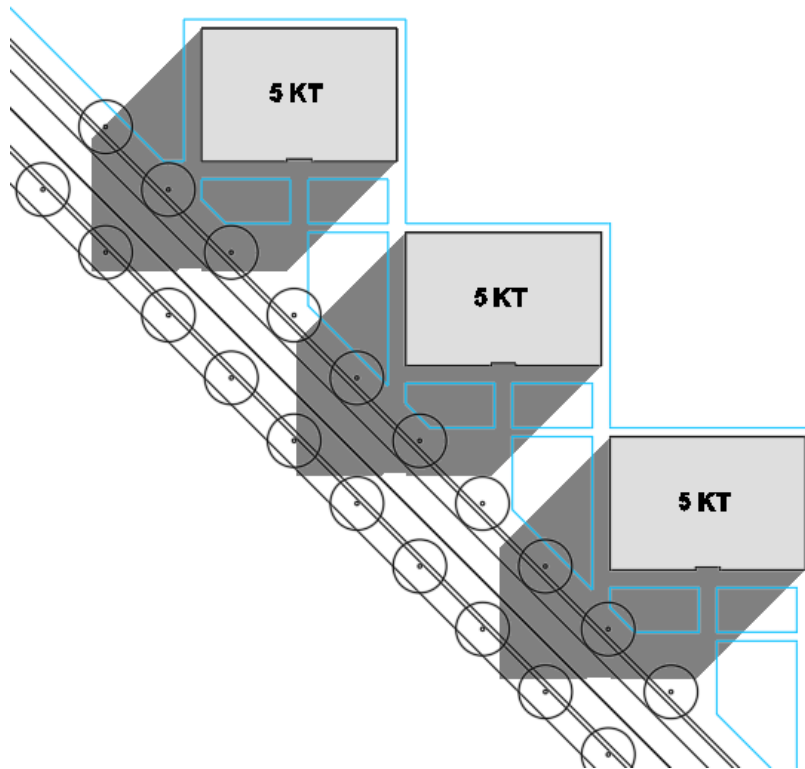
Model ilustrues i strukturave kolektive (pallat) paralele
